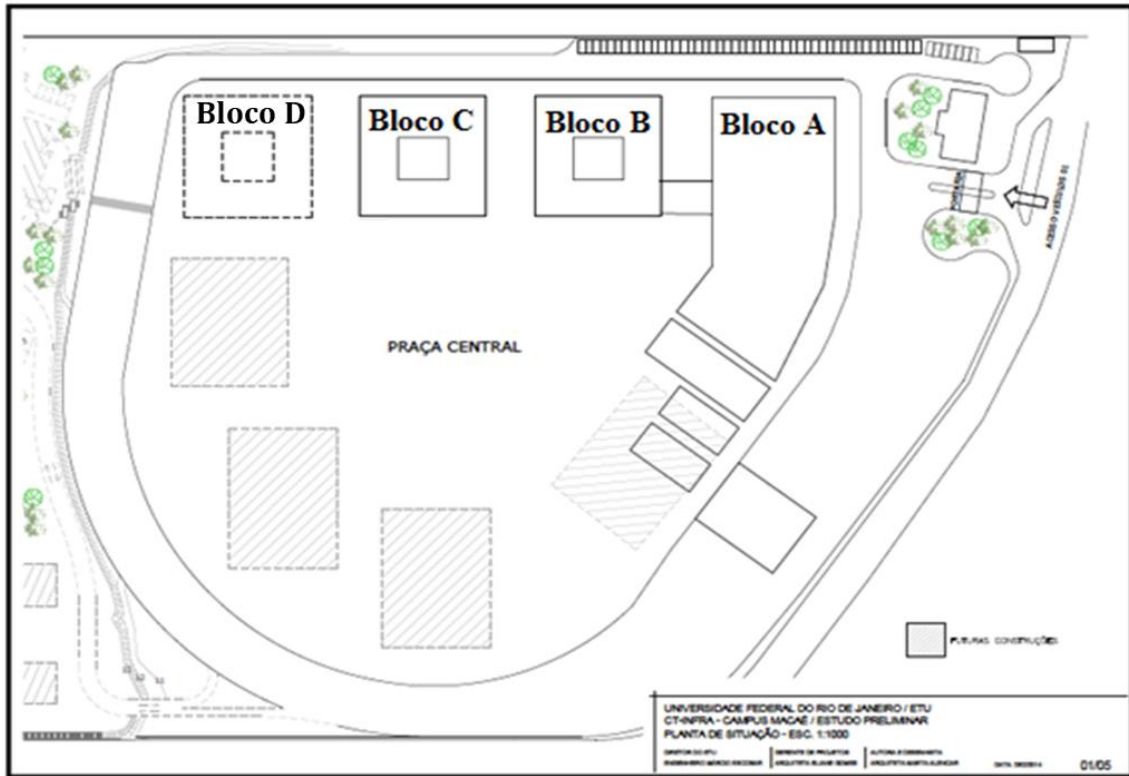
Planta de situação do Campus, Arquivo da UFRJ
